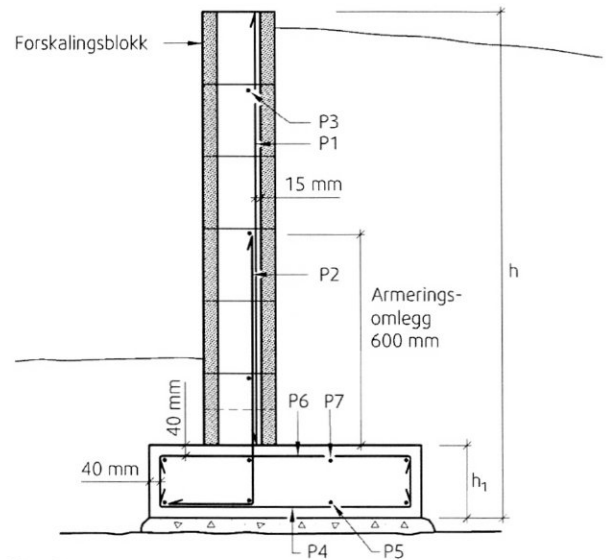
Plassering av betongarmering i utstøpt støttemur av Forskalingsblokk.
